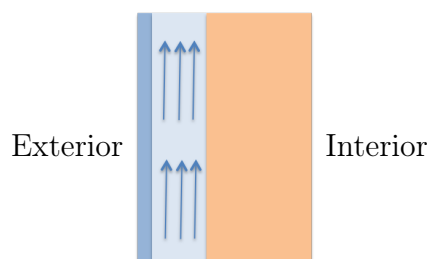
Esquema de fachada compuesta por: Elemento exterior ligero, muro interior masivo.
